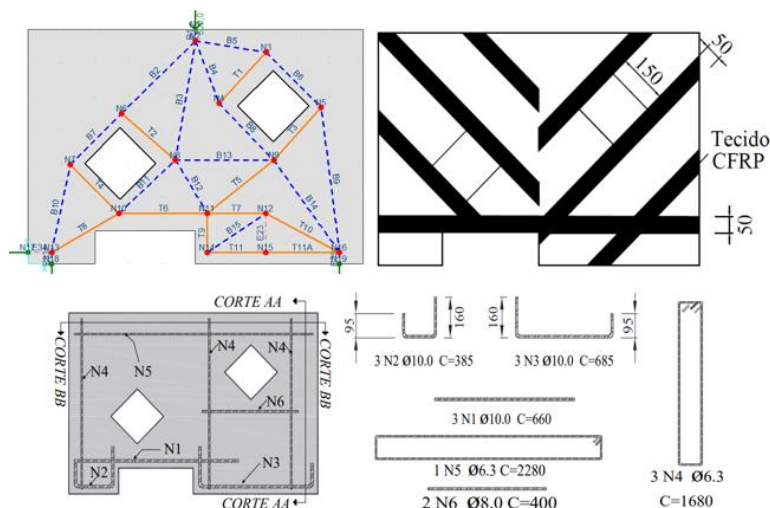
20 - Modelo de bielas e tirantes, armadura e reforço da viga-parede DB-WR-H2-S. Fonte: autor.
